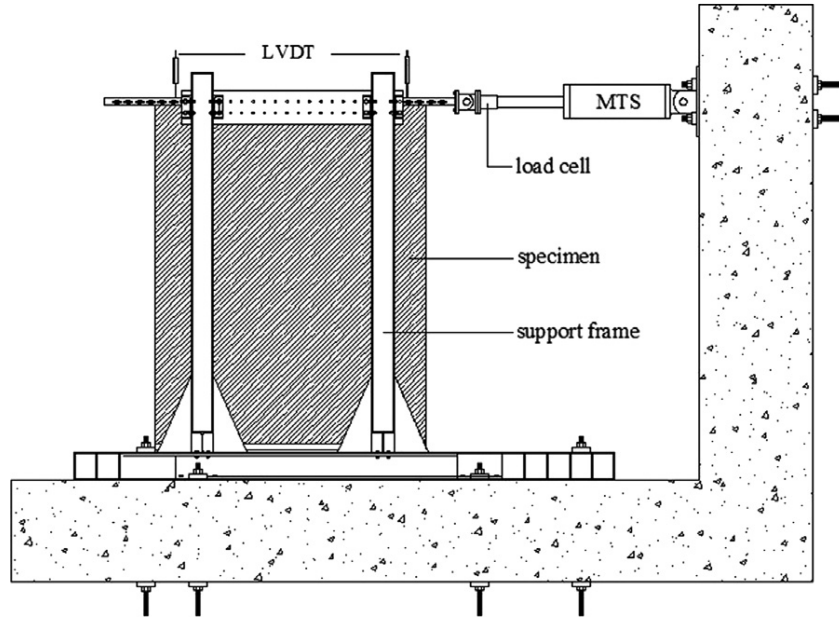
Configuração do ensaio (LIN et al., 2014)
